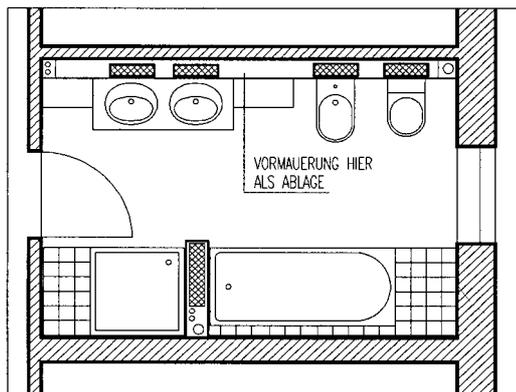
Badezimmer unter Verwendung von Installationsblocks (Pi, A47/2)
